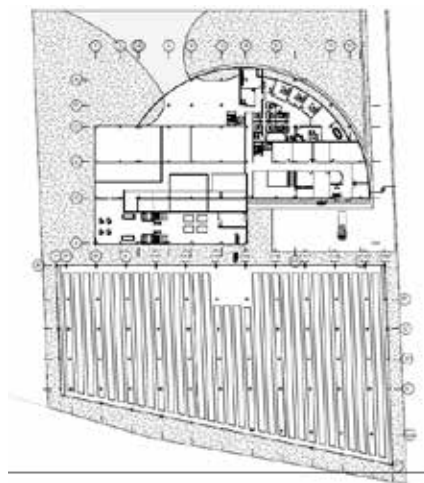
Imagen de Planta Baja conjunto del Centro de Acuicultura. Rodríguez y otros (2017)
